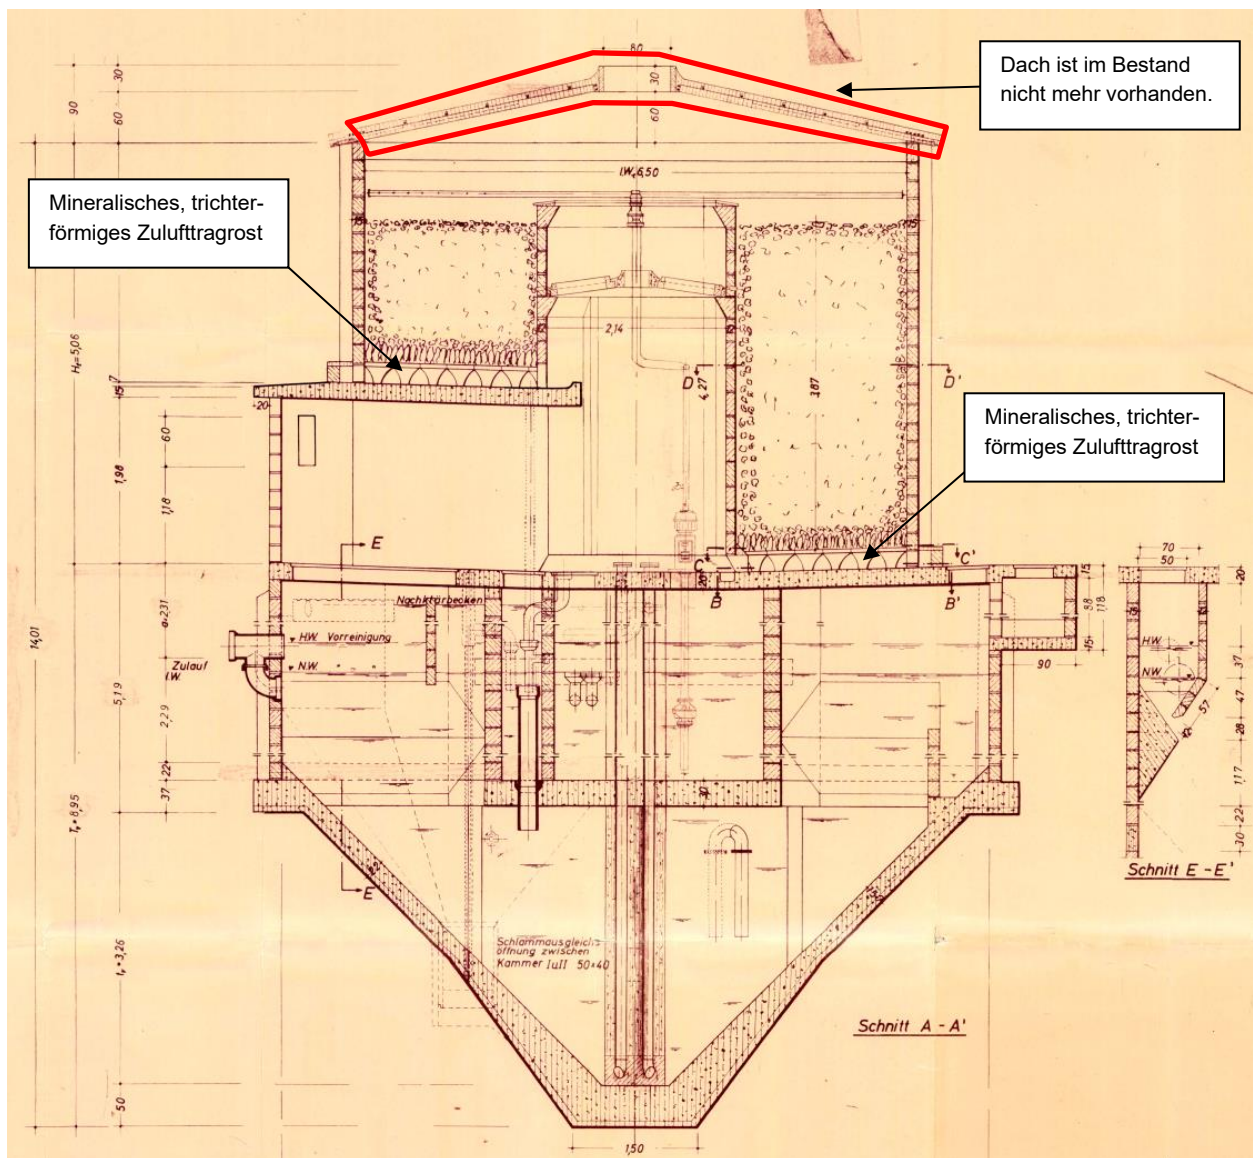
Schnitt - Ausschnitt aus Bestandsplan Tropfkörper KA Sandkamp. Die Gebäude wurden laut Aussage des AG baugleich ausgeführt
